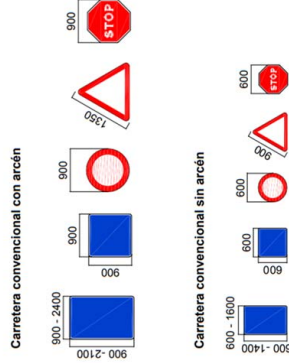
(Cotes en mm) Dimensions senyalització vertical. Instrucció de carreteres 8.1-IC
